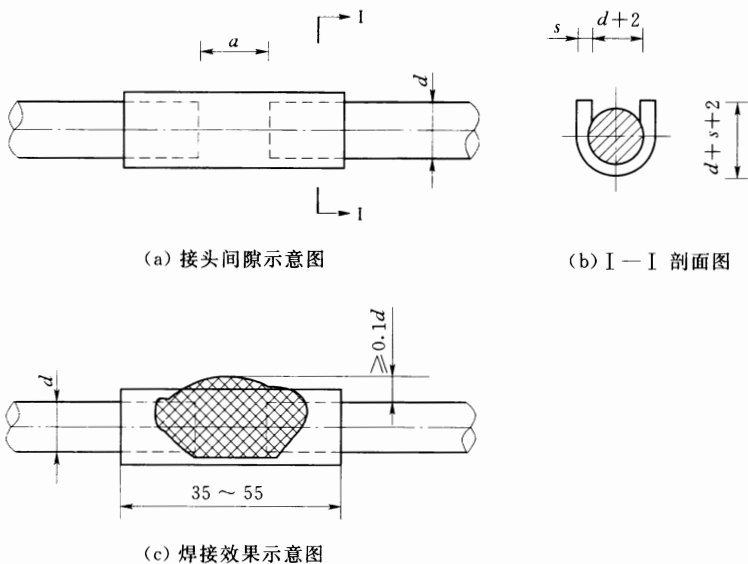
熔槽焊 (单位: mm)
